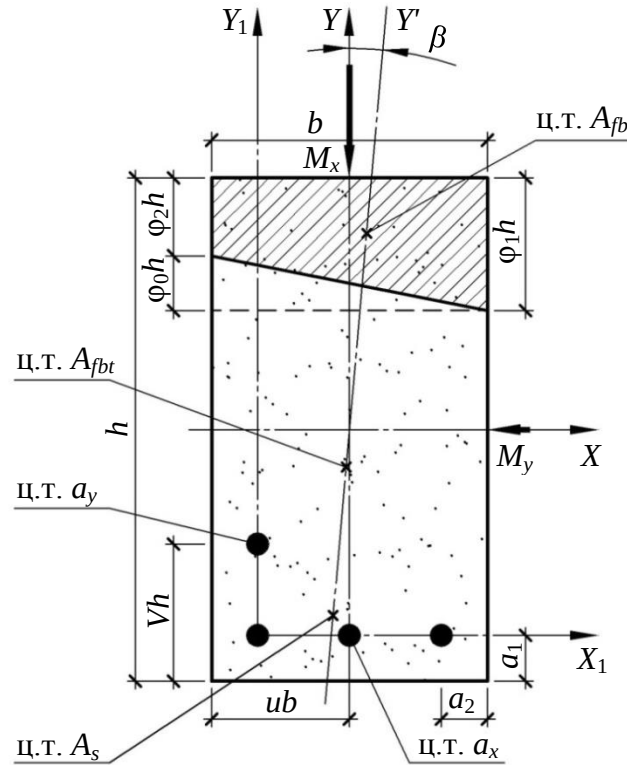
Расчетная схема косоизгибаемого фиброармобетонного элемента с трапецевидной формой сжатой зоны фибробетона
